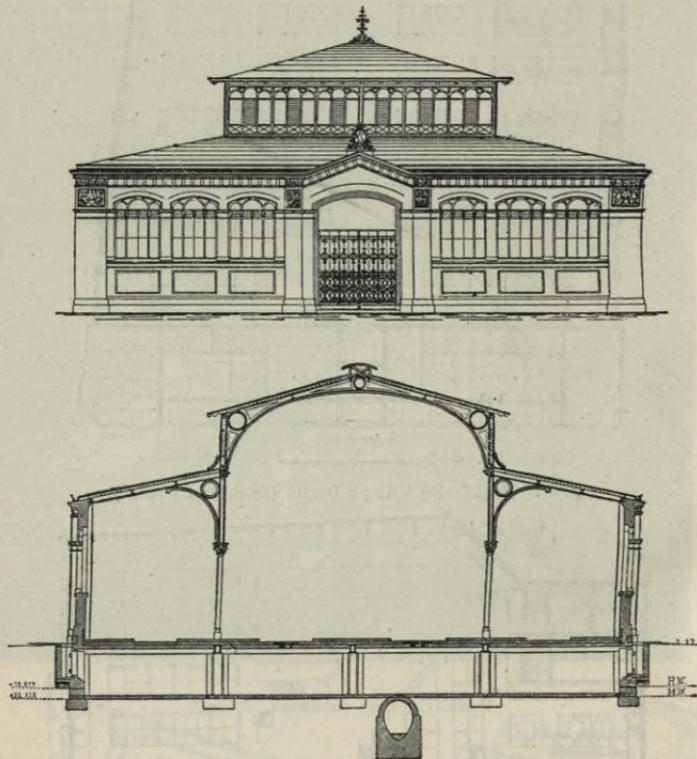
Markthalle VII. zu Berlin (Dresdenerstrasse).
